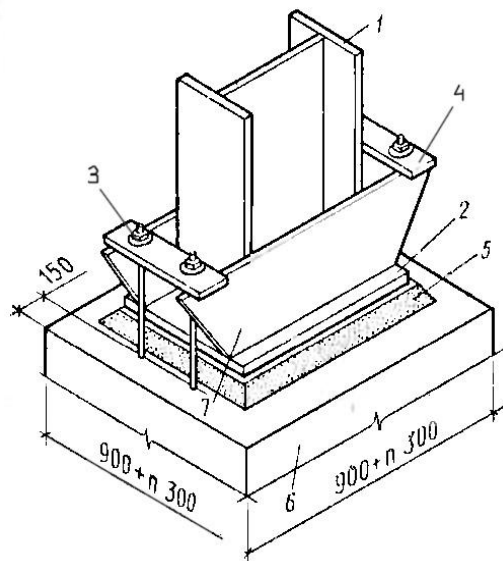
Монолитный железобетонный фундамент под стальные колонны.
